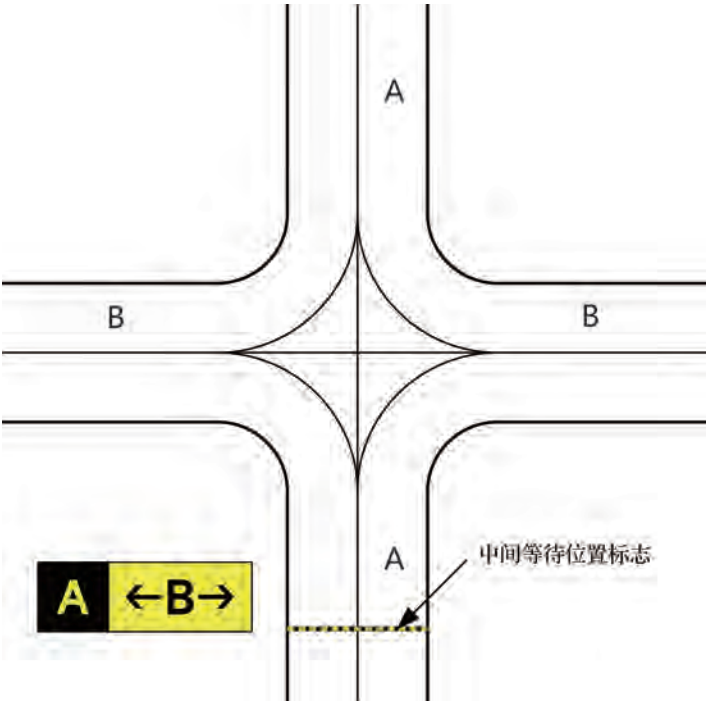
滑行道交叉处标记牌的布置示意图（一）
